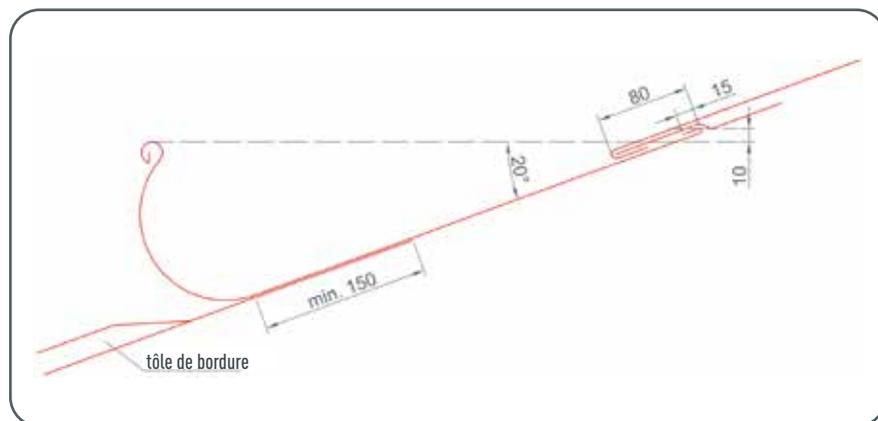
• Pente de toit minimum pour la gouttière havraise PREFA
